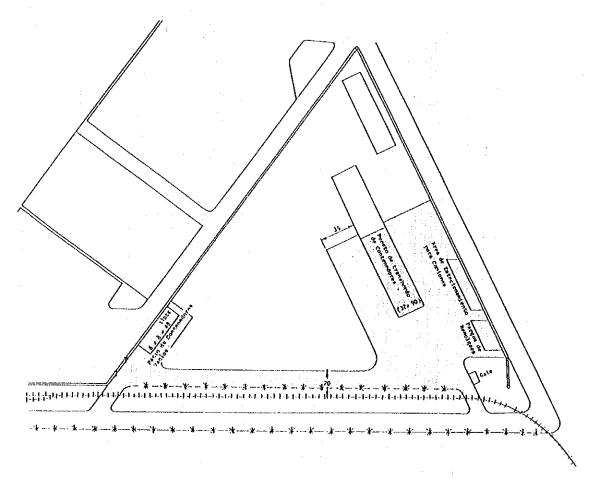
Plan de Disposición del Area de Puesto de Transbordo de Contenedores
